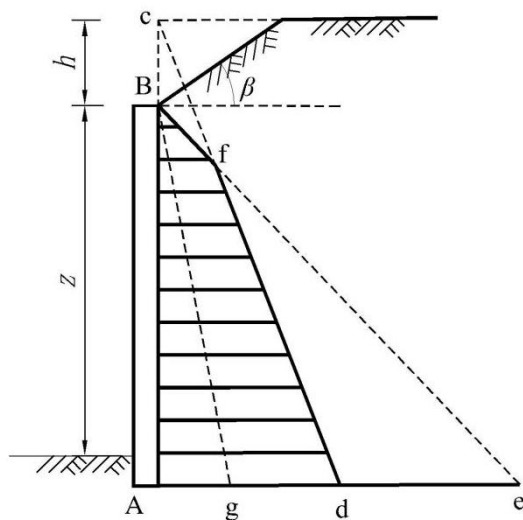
地面局部为斜面时支护结构上主动土压力的近似计算
